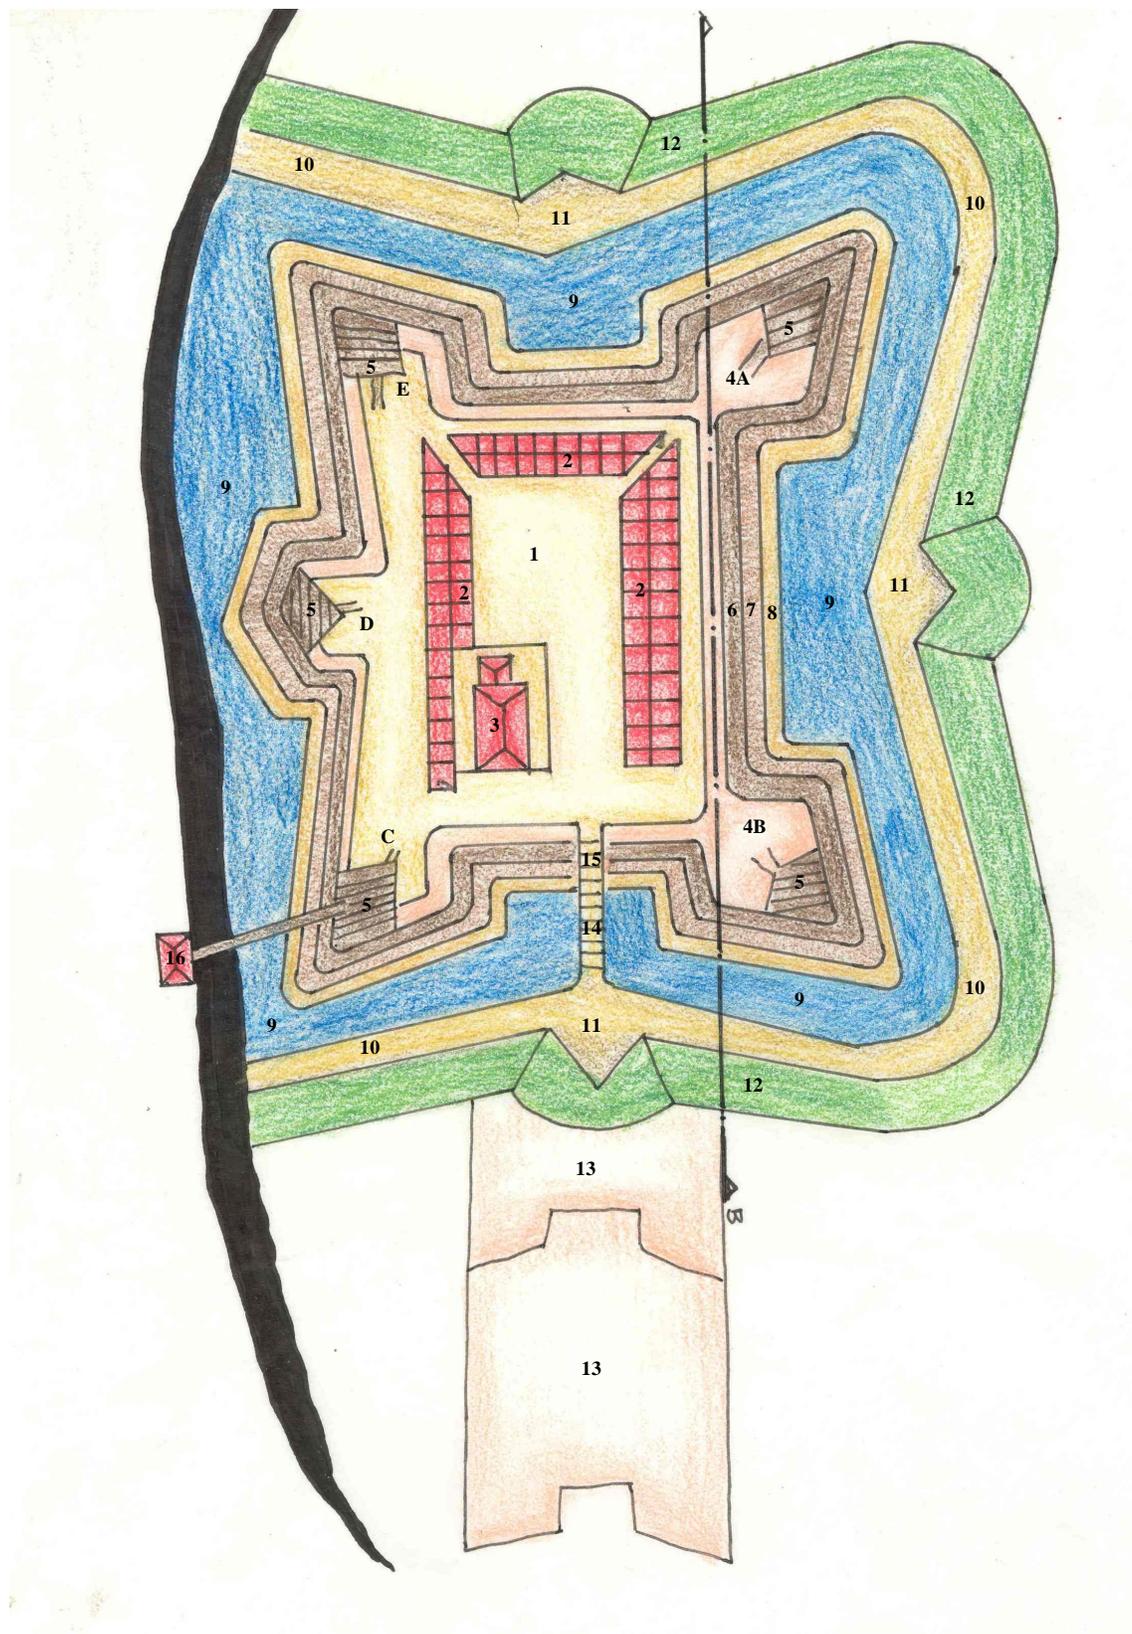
Planta do Forte Maurício a partir da imagem 85. Fonte: croqui da autora.
